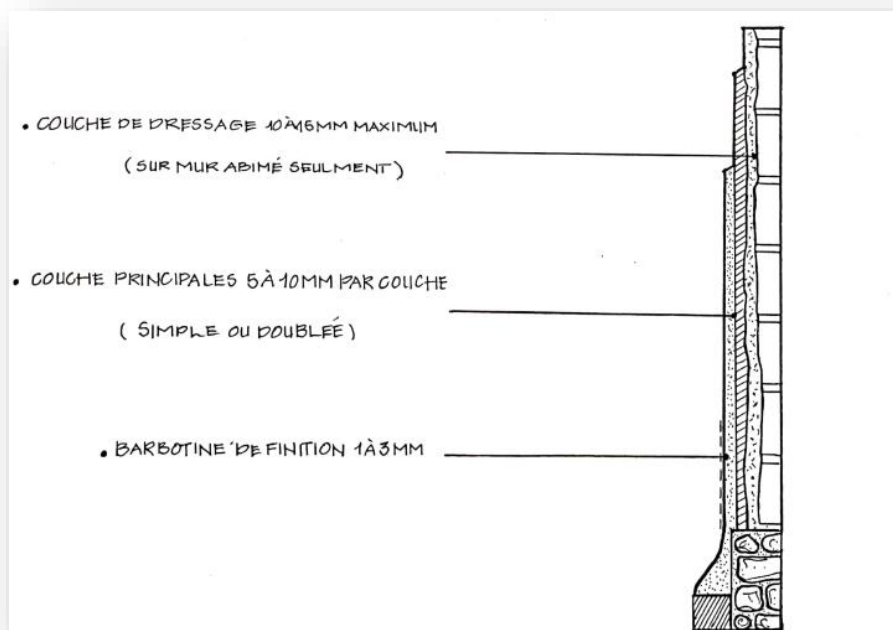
Reprise des différentes couches d'enduit. Source : Auteure .2022. Adapté de M. Jlok.2004.
